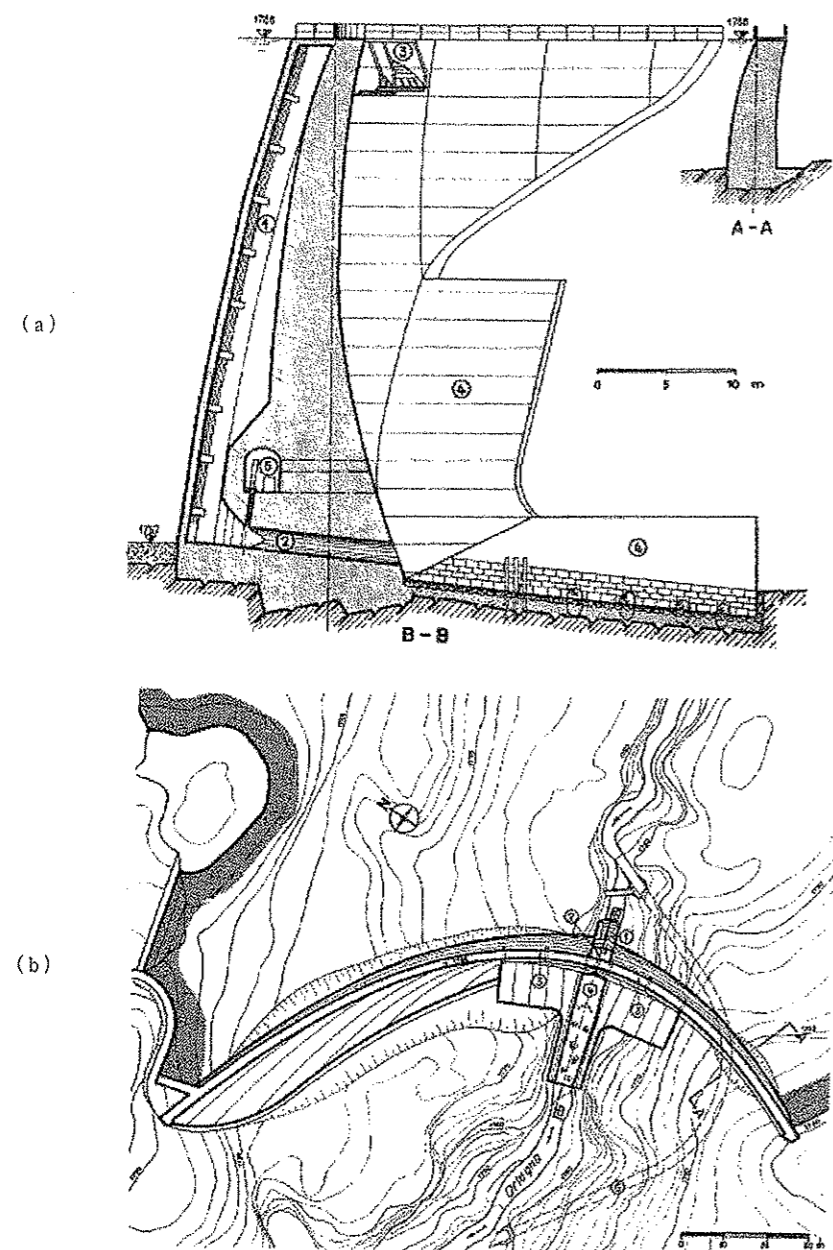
オルデンダム概要図 ((a)断面図, (b)平面図)
